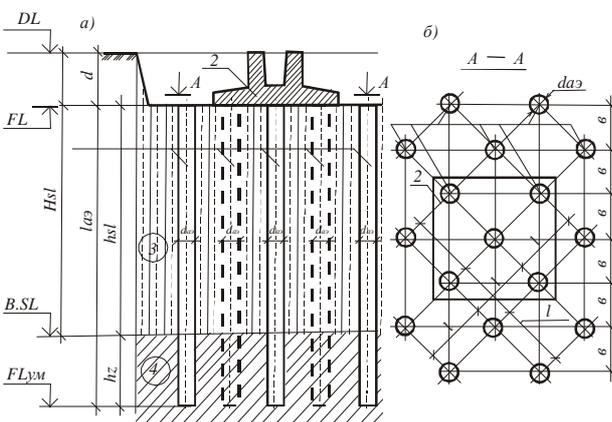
Схема армирования просадочного грунта основания: а - разрез; б - план
